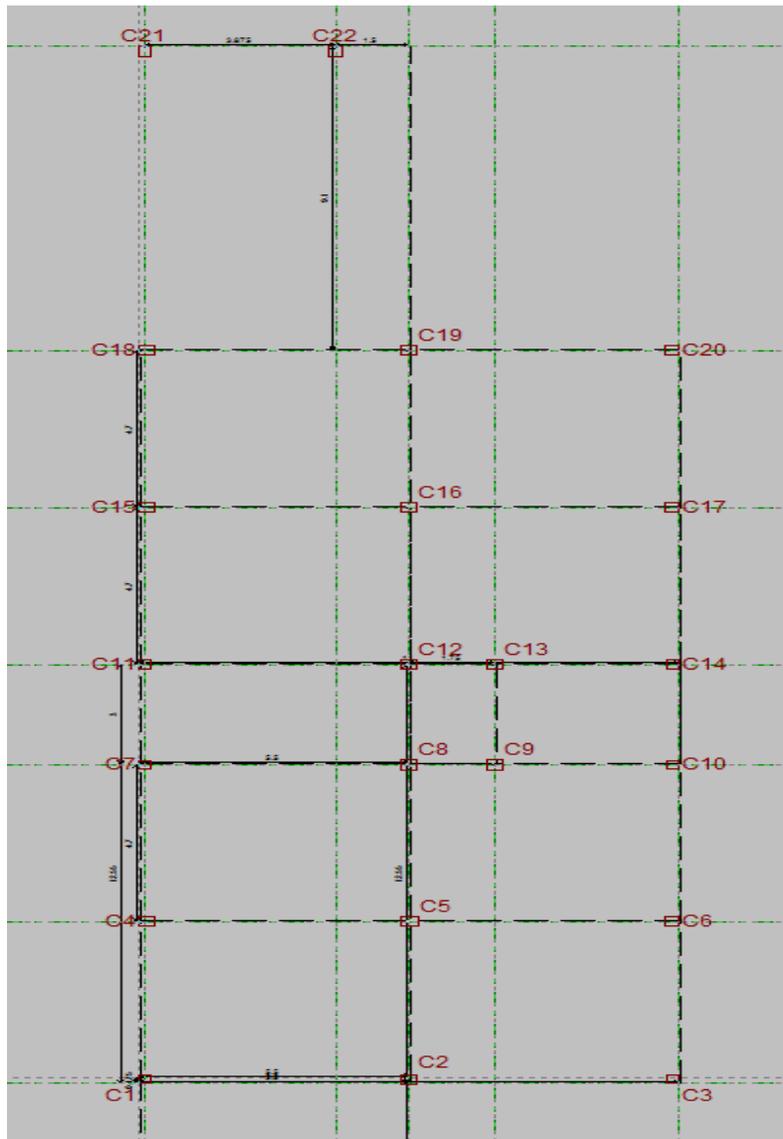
2 Viga más solicitada entre las columnas C18 – C19 – C20
